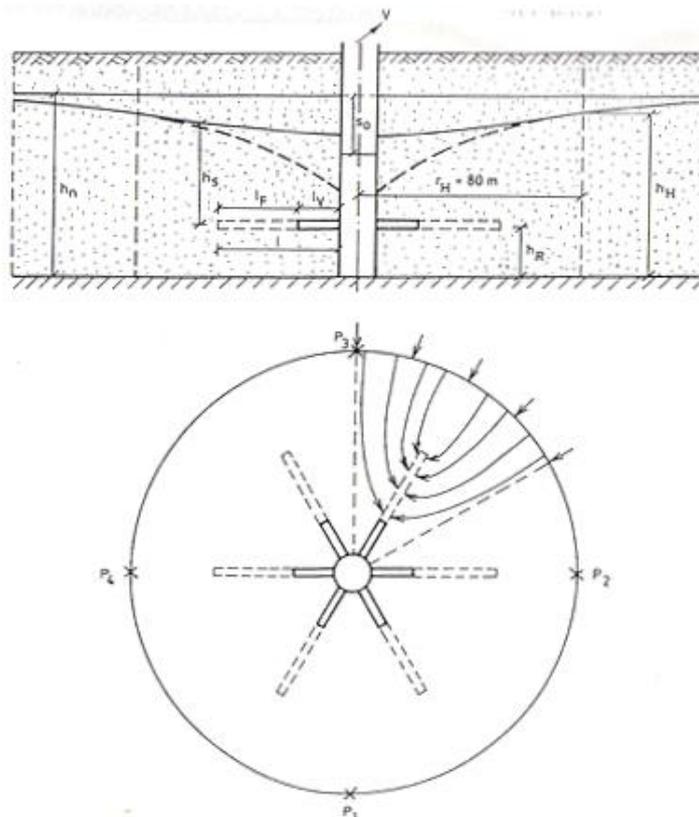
Schema HFB in Schnitt und Grundriss nach Balke et al. (2000, S.232)
